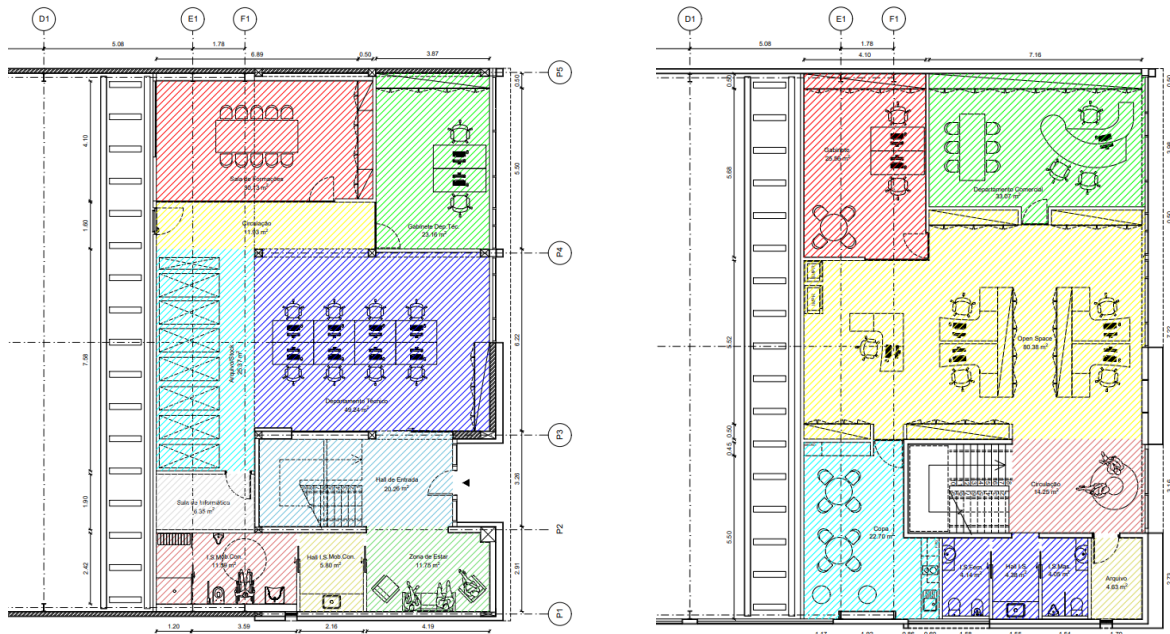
Proposto - Plantas do piso 0 e piso 1 (EP_R02). Fonte: Garq / Desenvolvimento: Autora.
